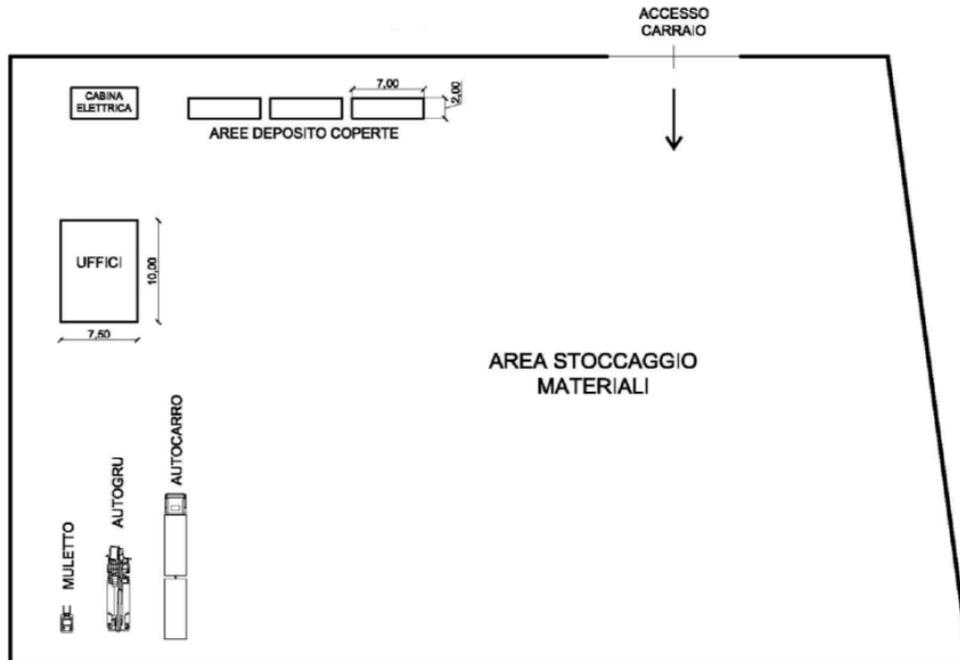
Pianta tipo area centrale o Base- le misure sono indicative
